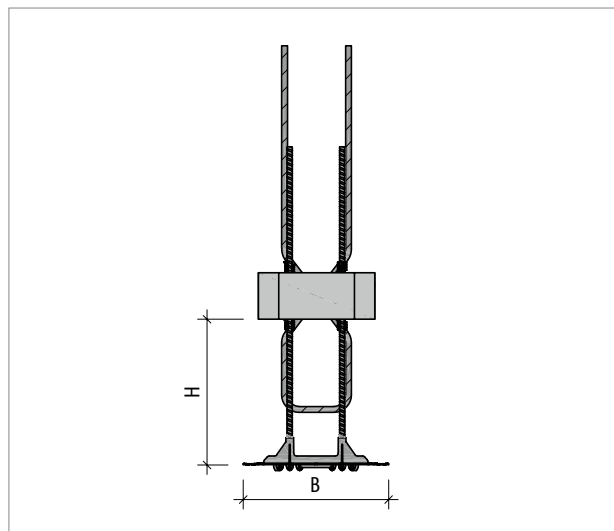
Schöck Sconnex® type W : coupe du produit avec aide au montage
